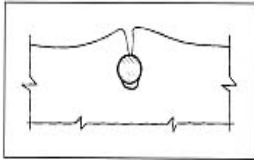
Fisura longitudinal por asentamiento del hormigón.
